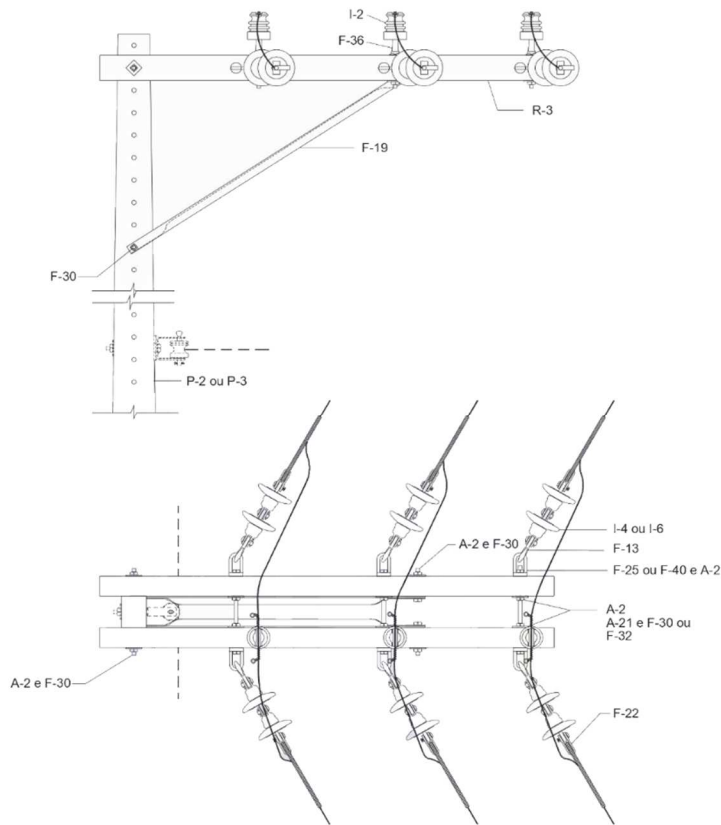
Primário – Estrutura B4 – Poste de concreto de seção circular
